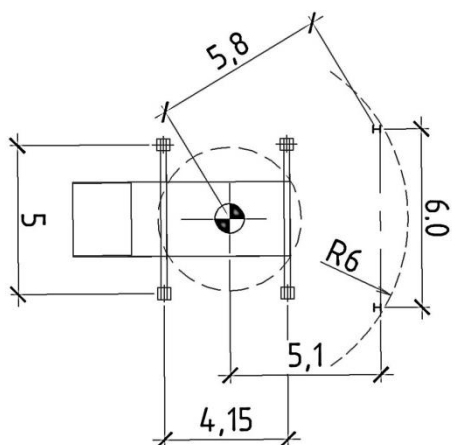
Расположение автомобильного крана для монтажа колонн
